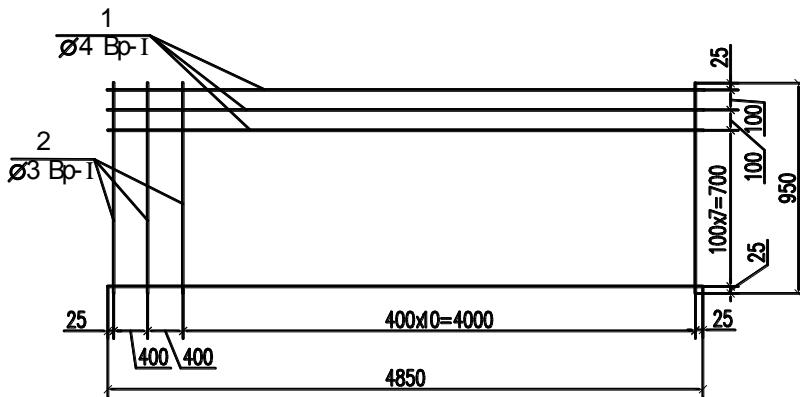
Ескіз сітки з поздовжньою робочою арматурою
